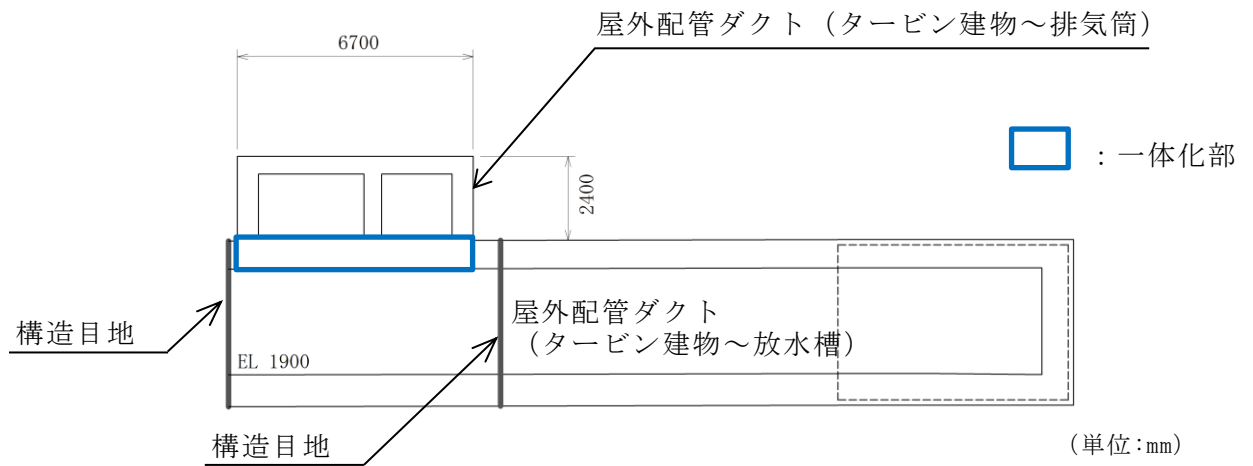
屋外配管ダクト (タービン建物～排気筒) 断面図 (B-B 断面)
